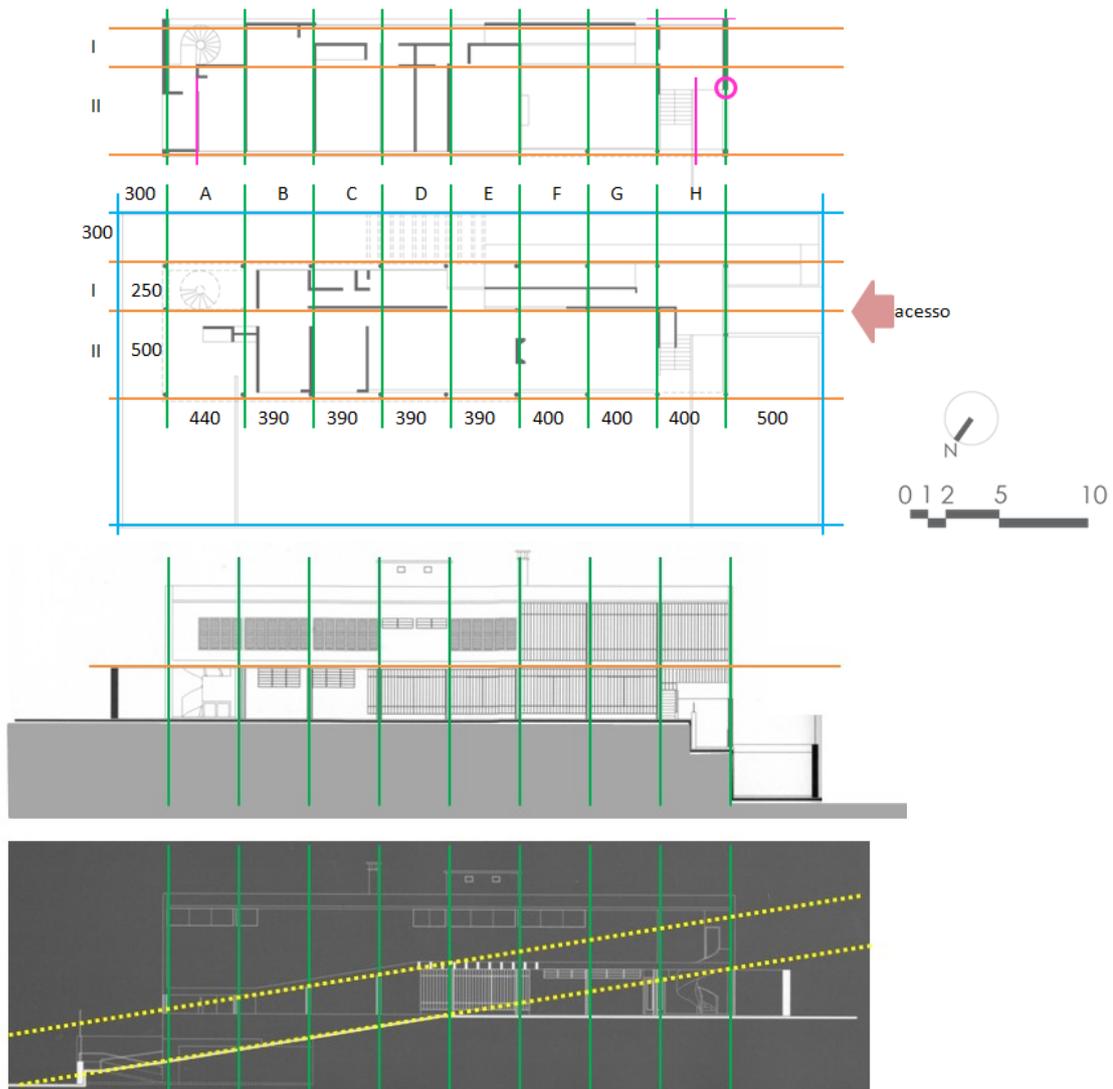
Residência Bettega, planta pavimento superior, planta térreo, elevação Noroeste e elevação Sudeste. Intervenções gráficas e possibilidades compositivas feitas pela autora. Plantas refeitas pela autora. Elevações disponíveis em <http://www.g-arquitetura.com.br/projetoartigas03.html>
